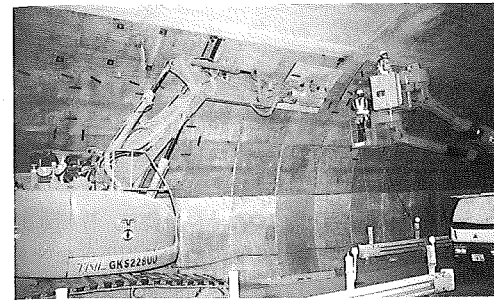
打ち増し部の設置状況(豊浜トンネル側)
